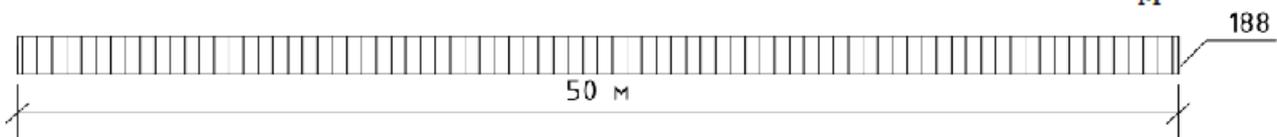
Схема распределения веса снегового покрова на плоской кровле здания
